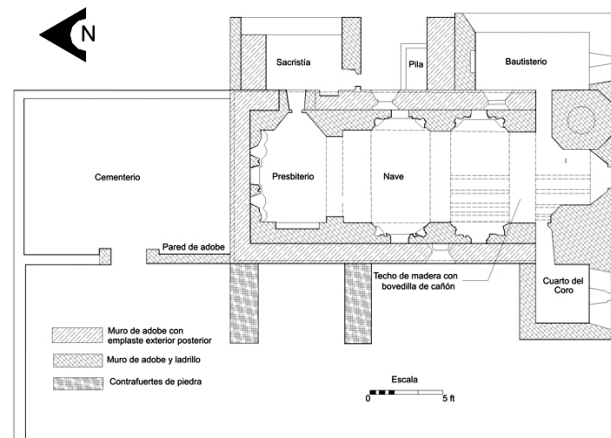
Planta del templo que muestra sus diferentes etapas constructivas
